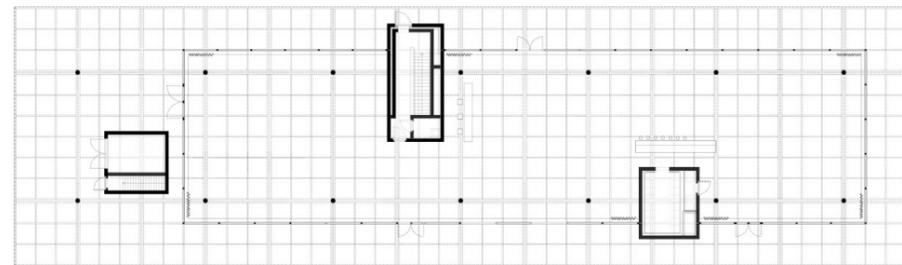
Grundriss, Erdgeschoss, Werkraum Andelsbuch, Atelier Peter Zumthor & Partner
